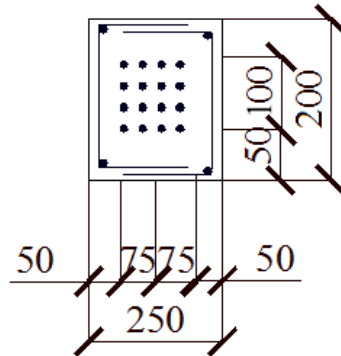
Схема розташування арматурних стержнів в перерізі нижнього поясу ферми
